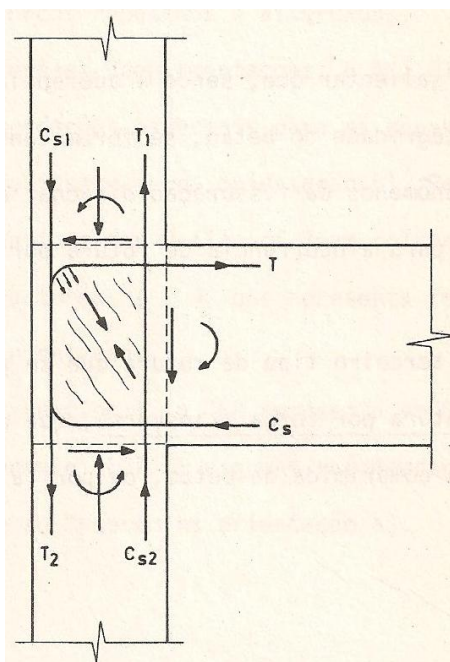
Fissuração diagonal na ligação (LNEC, 1977)
